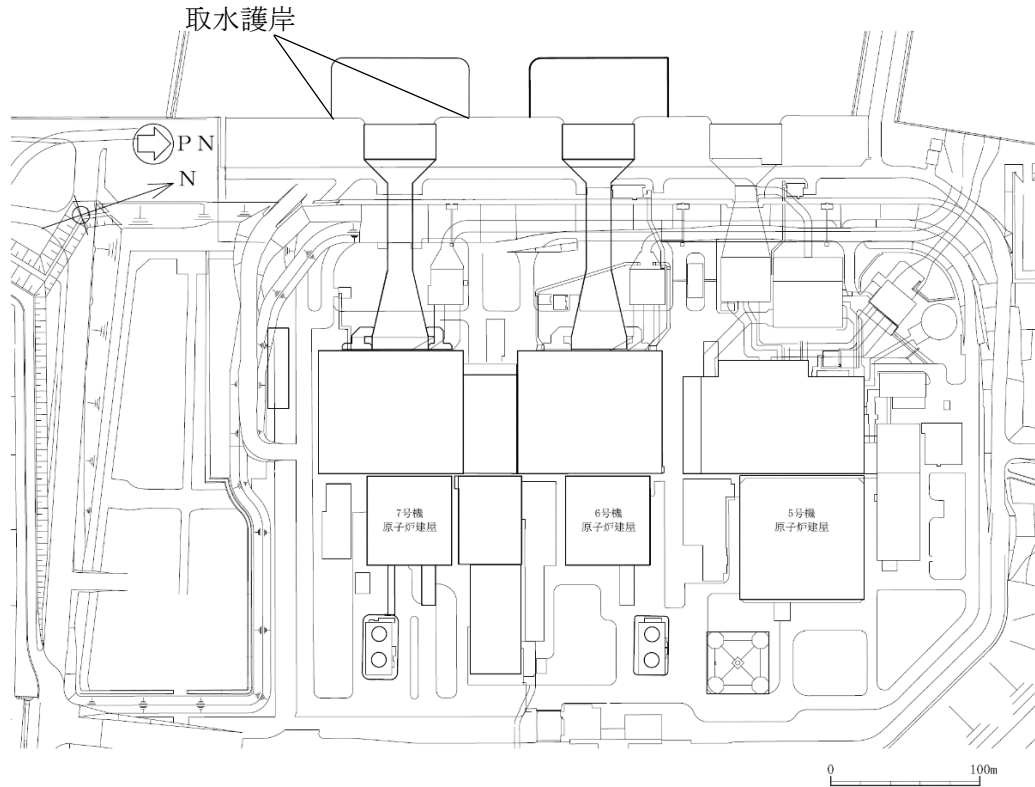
(1) 取水護岸の位置図 (全体平面図)
